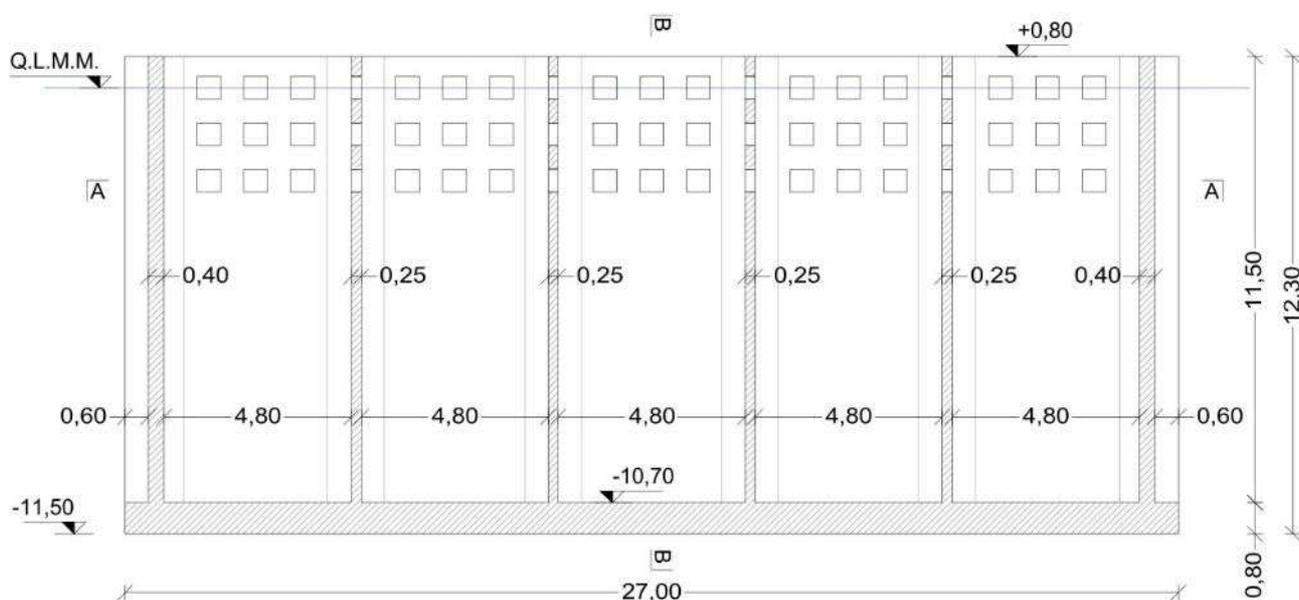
Cassoni tipo 1: Carpenteria - Sezione verticale longitudinale C-C
